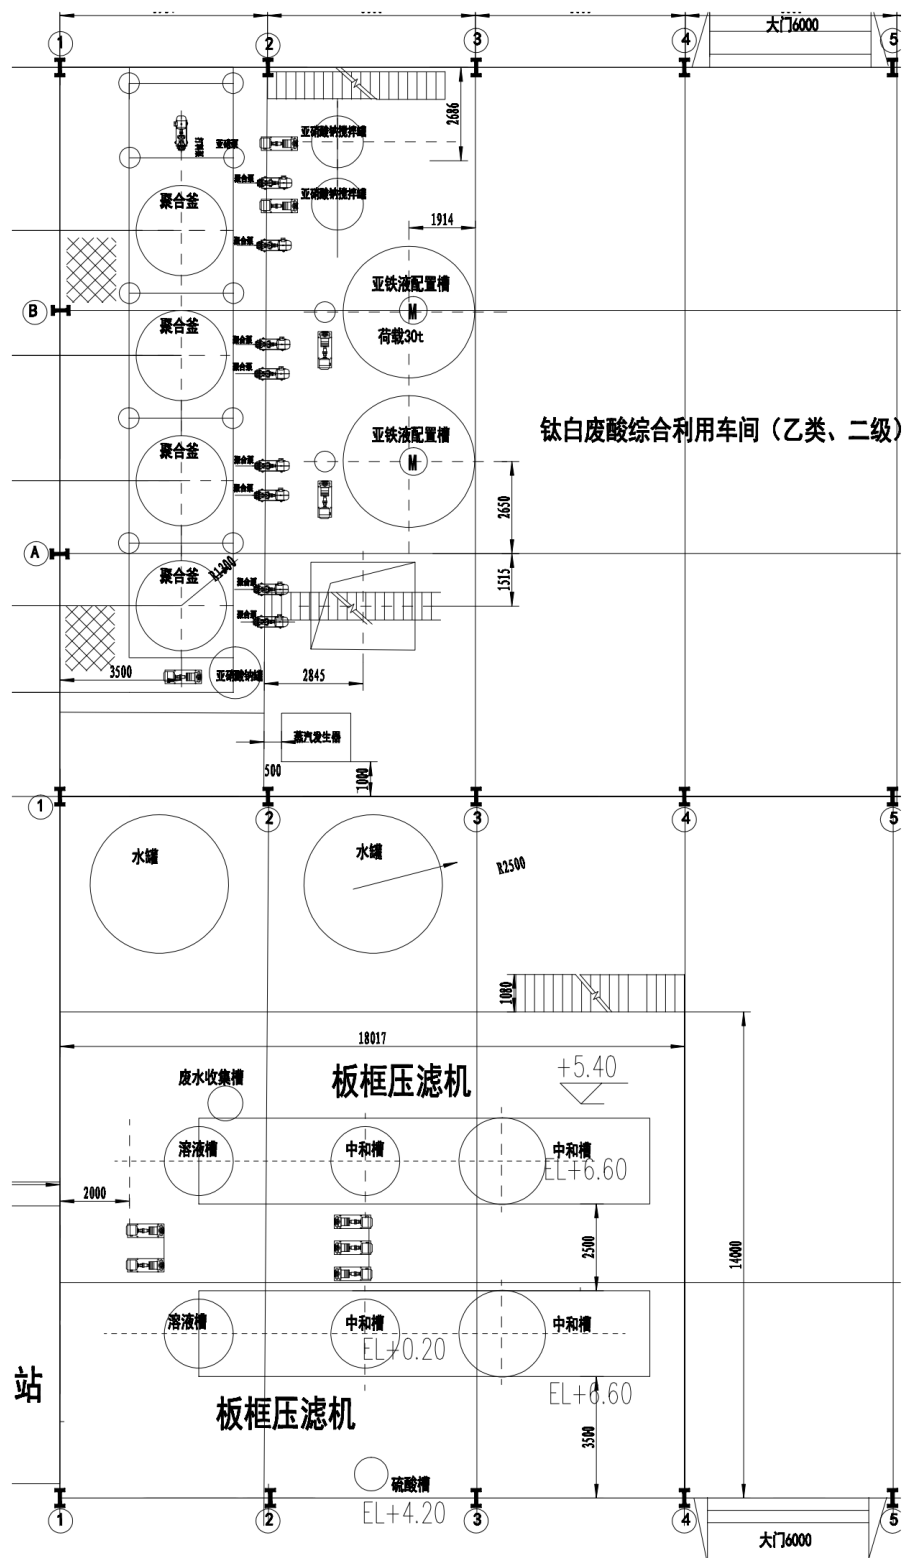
压滤车间和钛白废酸综合利用车间实际建设平面布置图
